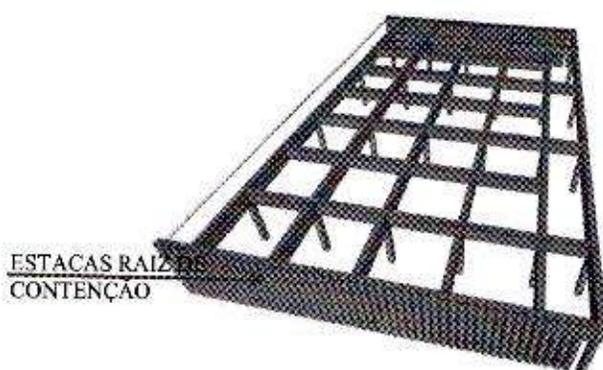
Vista da estrutura (sem as lajes e sem a viga sobre as estacas raiz de contenção)
